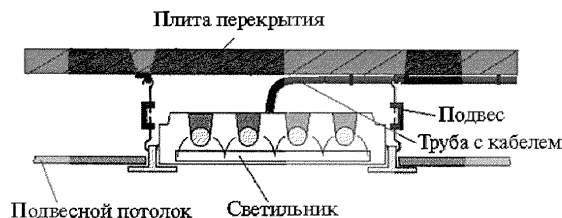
Крепление светильника с люминесцентными лампами к плите перекрытия
